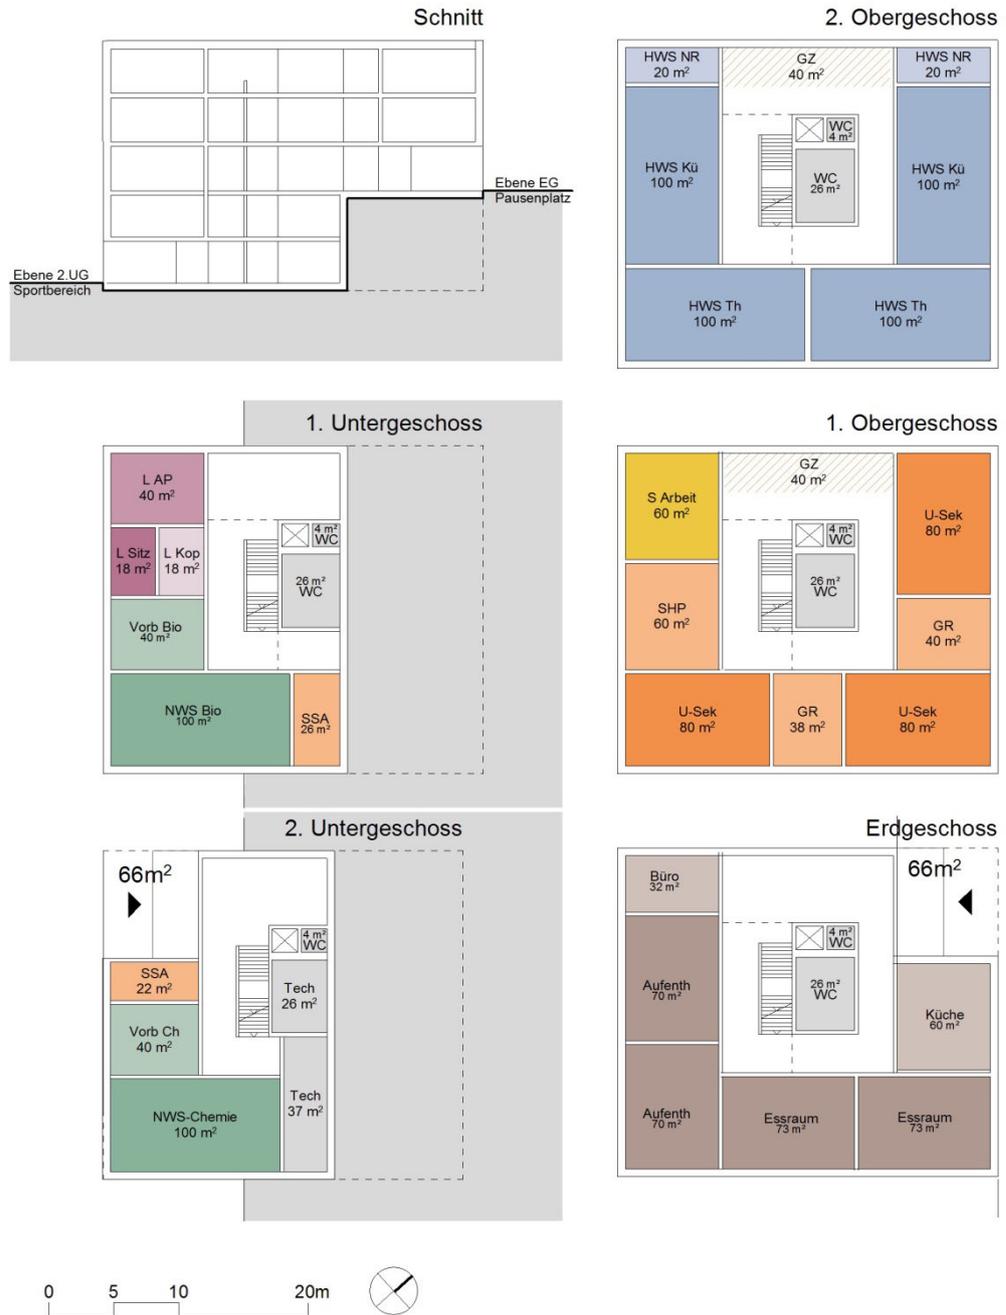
Variante 3, Erweiterungsbau Sekundarstufe Loreto
